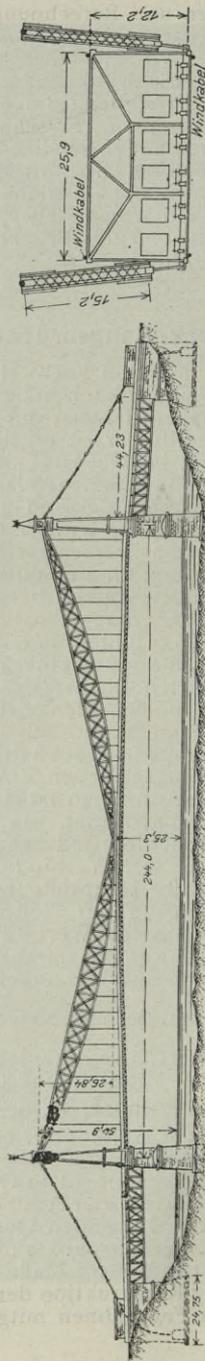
a-c. Hängebrücke über den Monongahela bei Pittsburgh. Hängebrücke mit Fachwerk-Hängeträgern und drei Gelenken.
